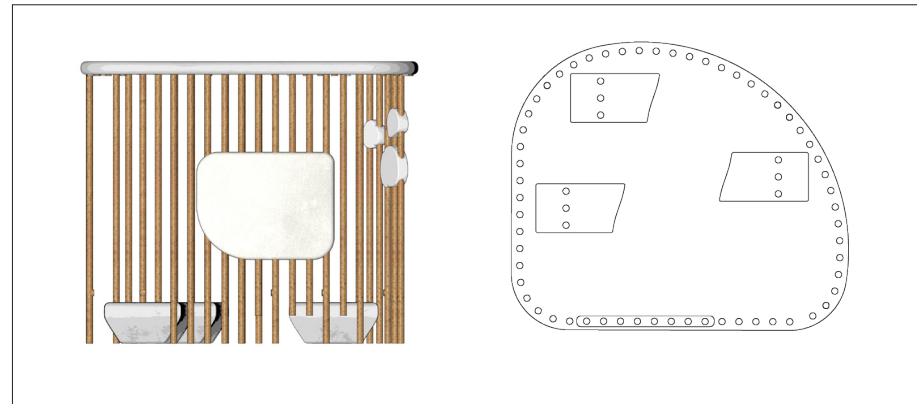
Alzado y planta de la propuesta de aproximadamente 8m².
